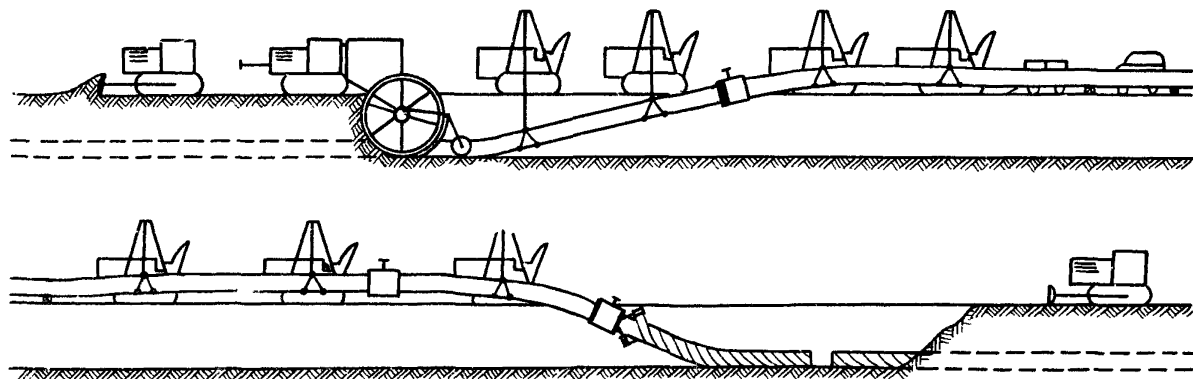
Рис. I. Схема капитального ремонта газопровода на берме траншеи
